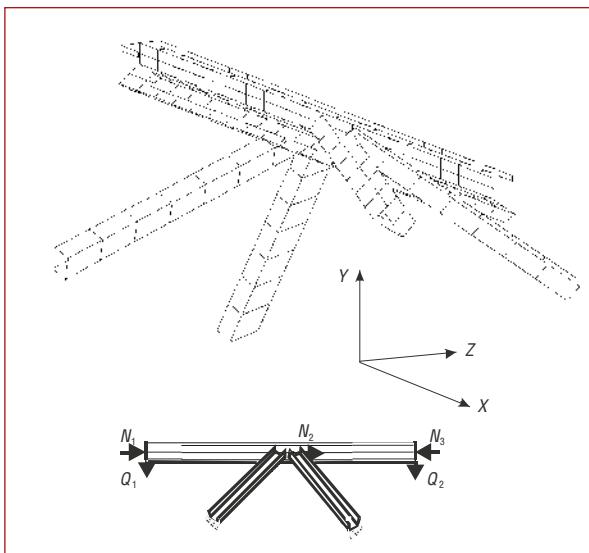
Расчетная схема узлового сопряжения: а — узел конструкции, описанный набором четырехугольных пластин — КЭ; б — внешние закрепления и нагрузки на узел
